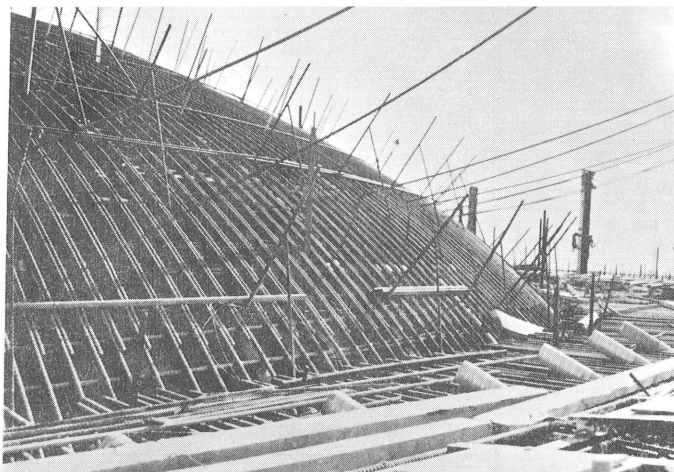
Perfil de la cúpula, con las fases de hormigonado.
